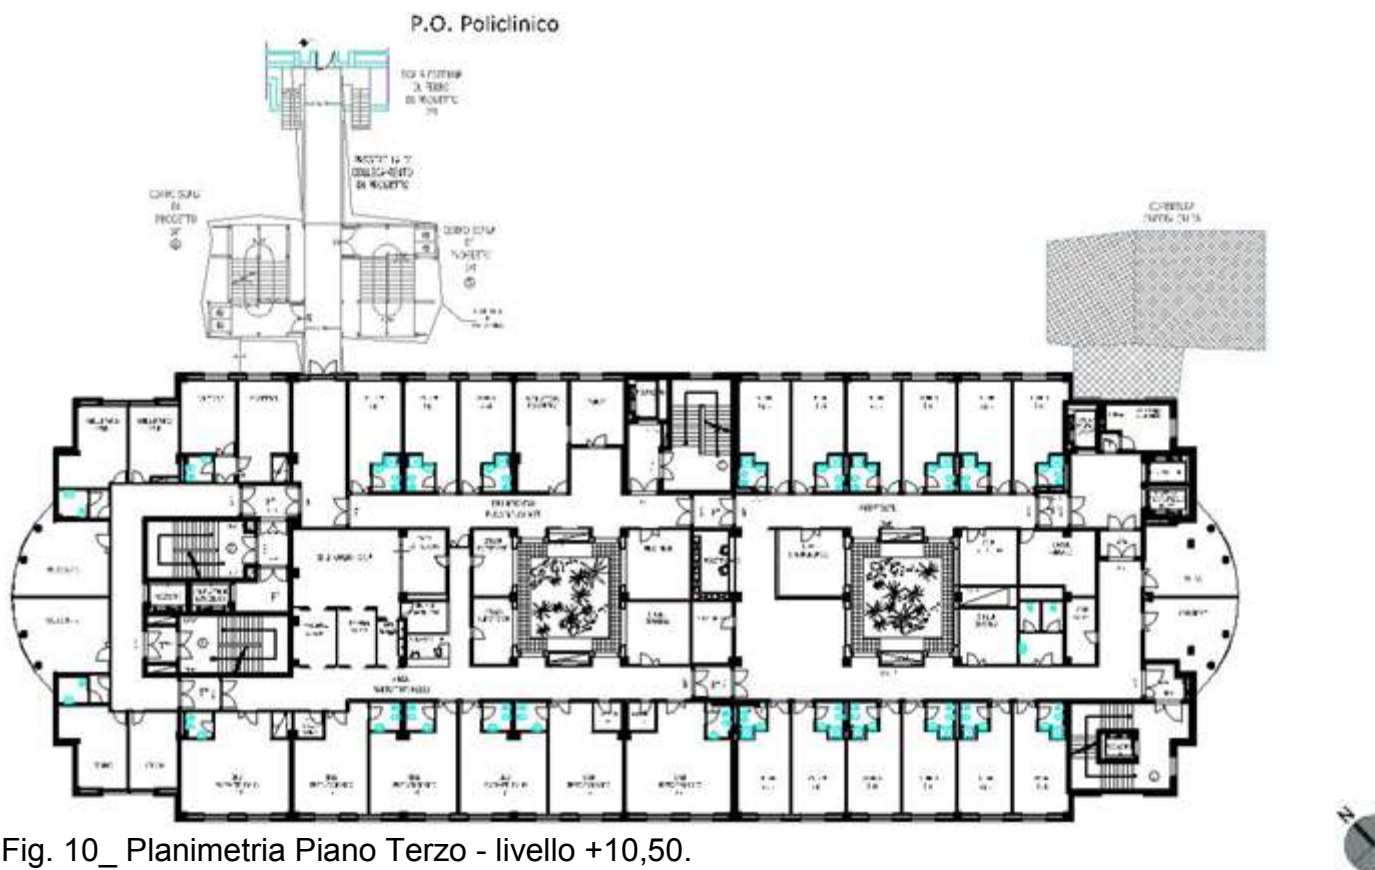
Planimetria Piano Terzo - livello +10,50.
